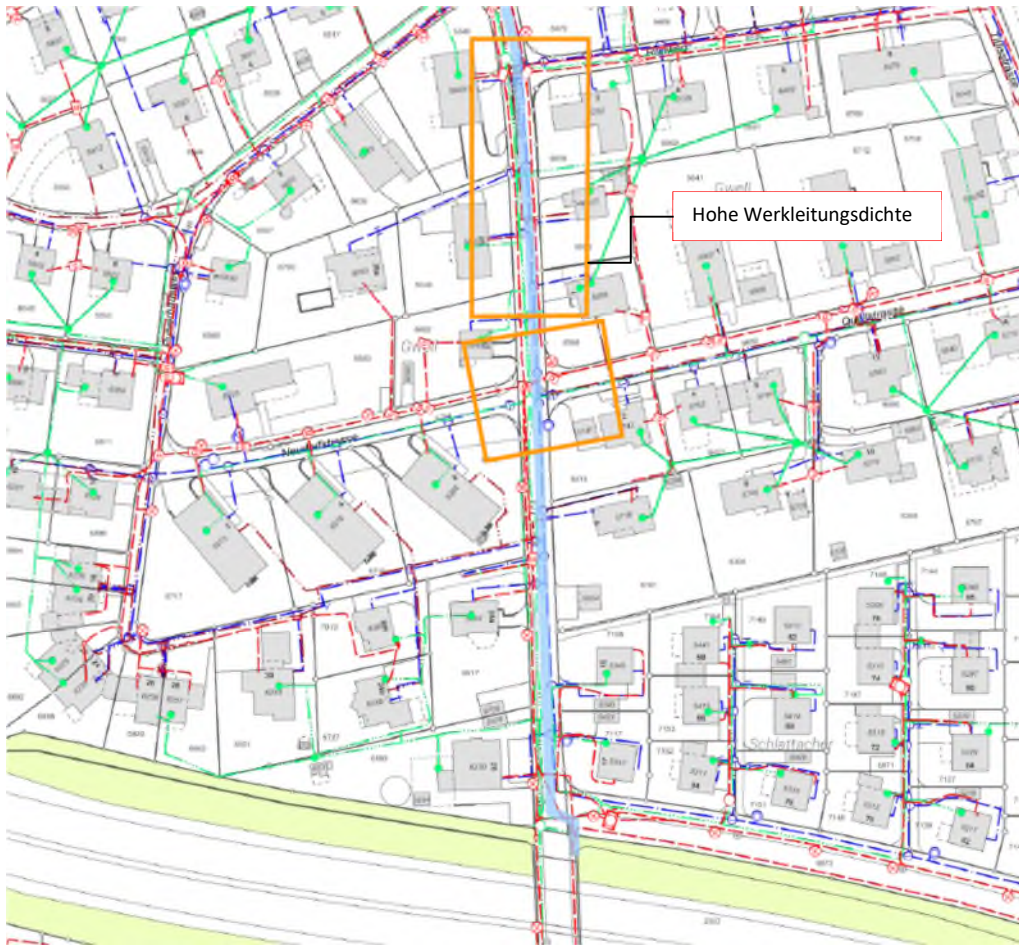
Brücke T5 Pilatusstrasse bis Hauptstrasse Aarau – Rohr
